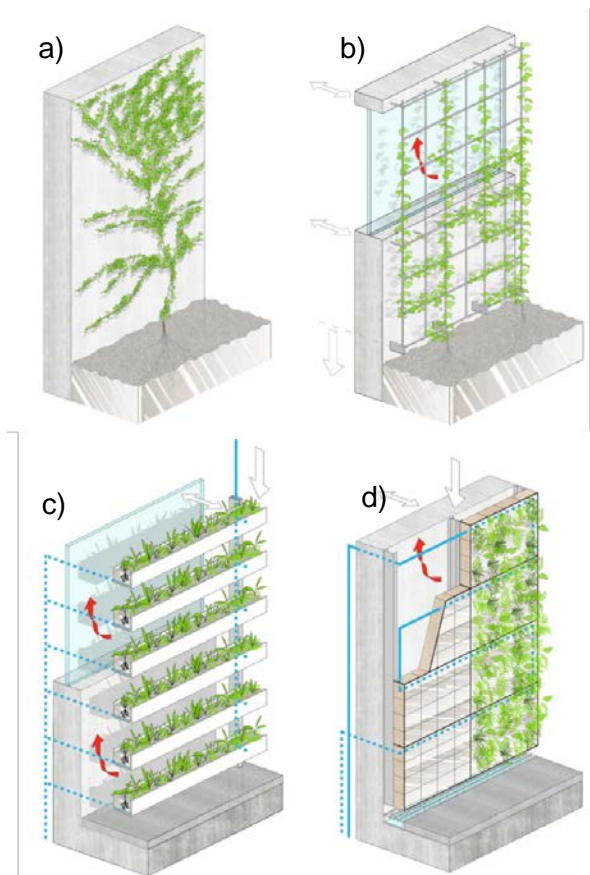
Ausbildungsformen der Fassadenbegrünung a) mit Selbstklimmer b) mit Gerüstkletterpflanzen c) wandgebundenes lineares System d) wandgebundenes modulares System; Types of facade greening a) climbing plant without frame b) climbing plants with frame c) in-line living wall d) modular living wall [2]
